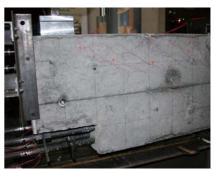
コンクリートの中の鉄筋を引き抜く要素実験 Figure 2 : Pull-out test of deformed bars in a
